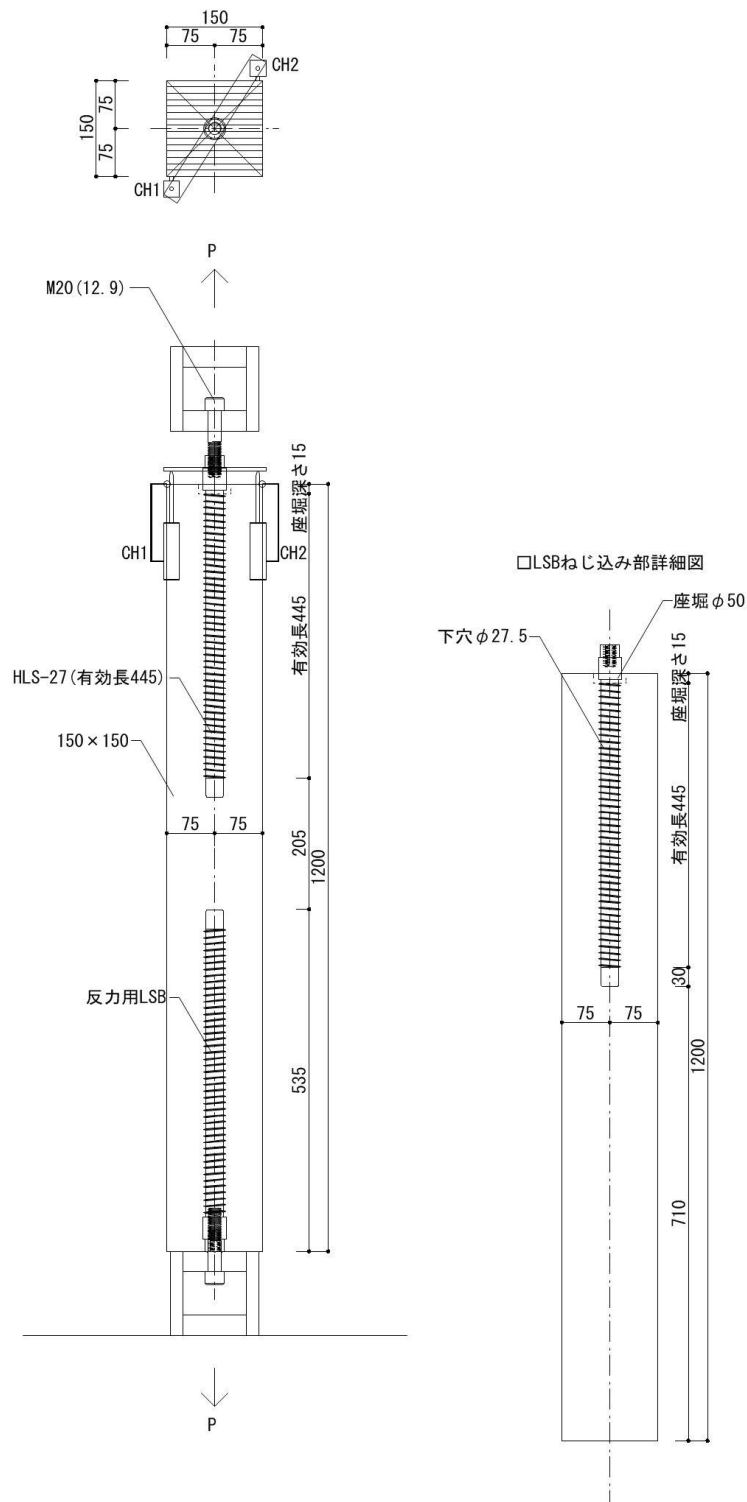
試験体の形状及び寸法 (C-1)
